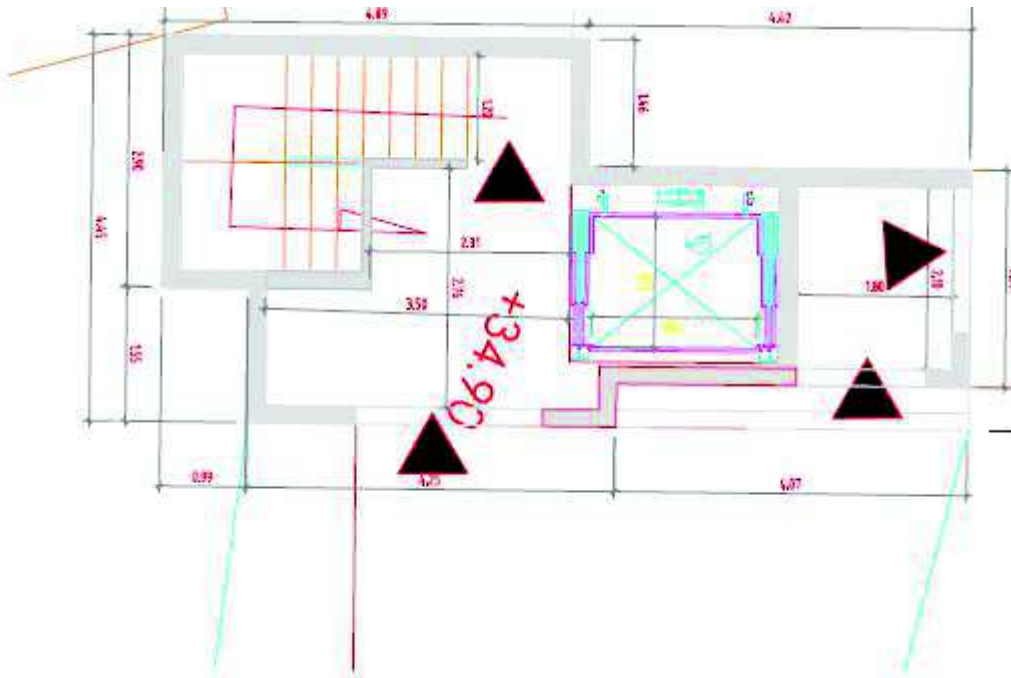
Torre lato Green Village (sezione orizzontale)
